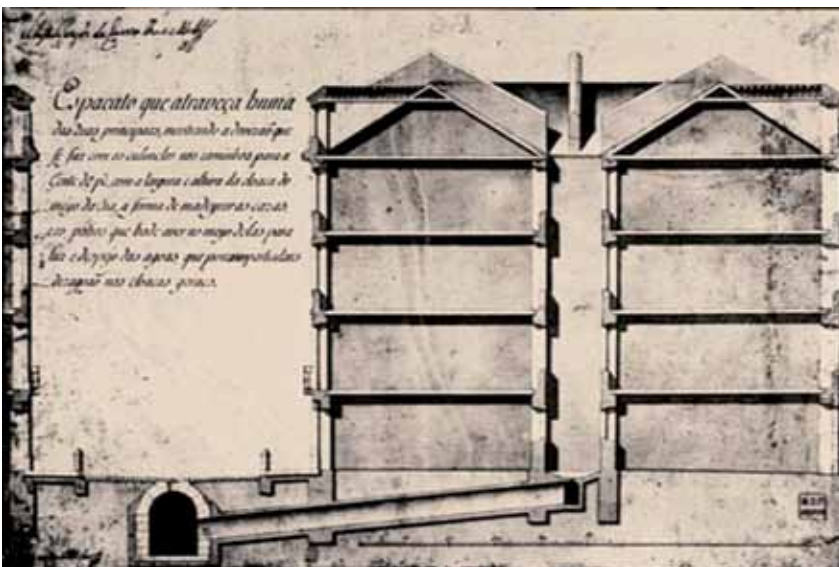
Sección donde se aprecian las bajadas y evacuación de aguas pluviales. Aparece el drenaje de las aguas pluviales de un patio interior, pero no de las aguas residuales de las viviendas.
